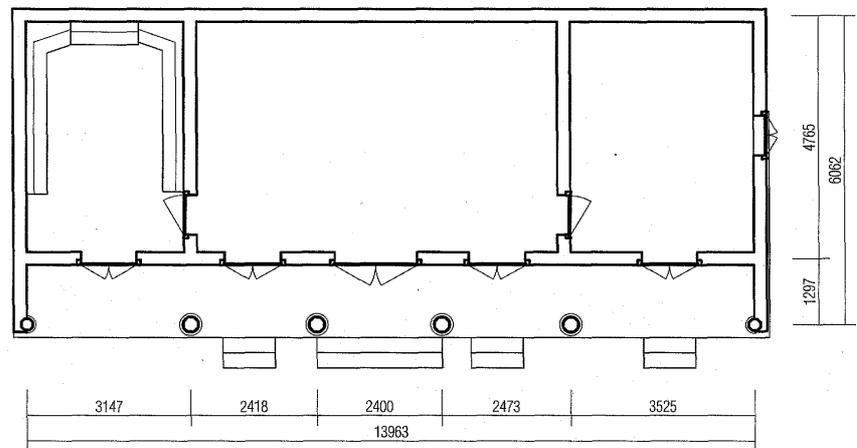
ファン・ケ・トアイ記念館 平面図 1:150
